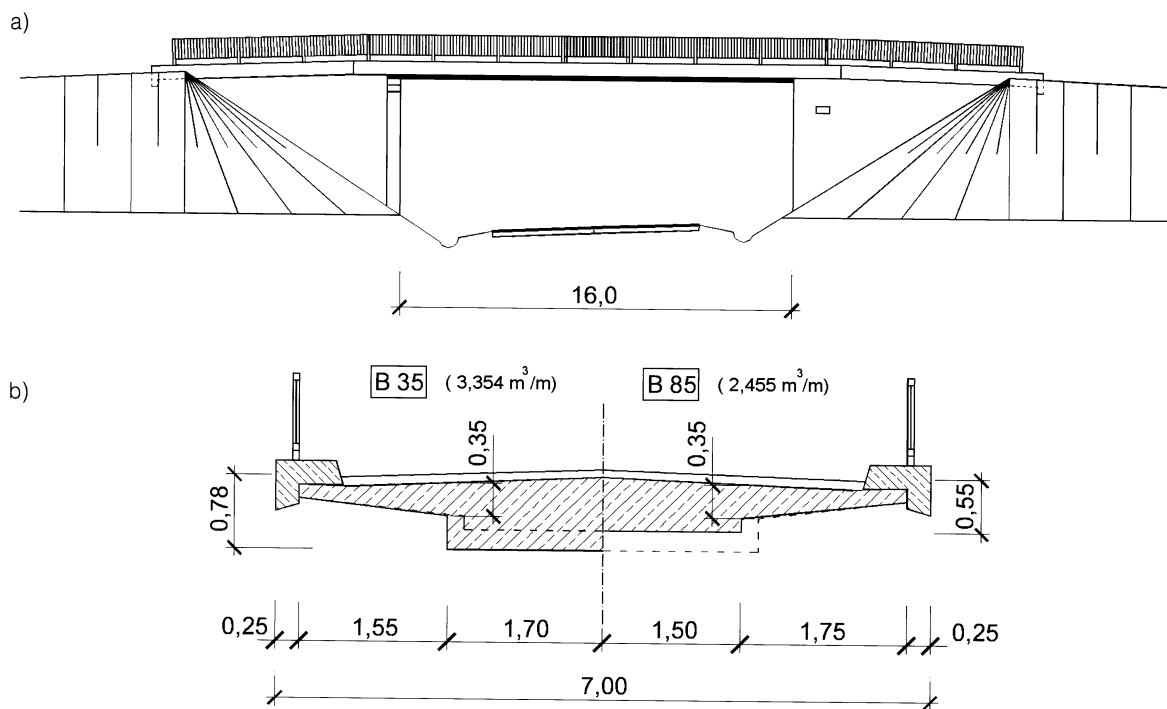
Kładka o płytowej konstrukcji nad rzeką Gera (Niemcy, 1998): a) schematyczny widok obiektu, b) przekrój płyty; 1 – płyta prefabrykowana z betonu lekkiego BL44, 2 – słupy z betonu B85, 3 – wkładki sprężone z betonu 130 MPa
